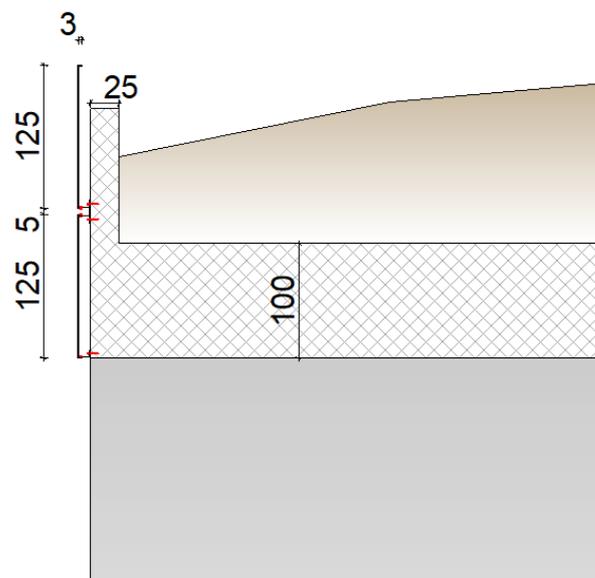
Sezione trasversale rivestimento imbocco galleria Bucciano
